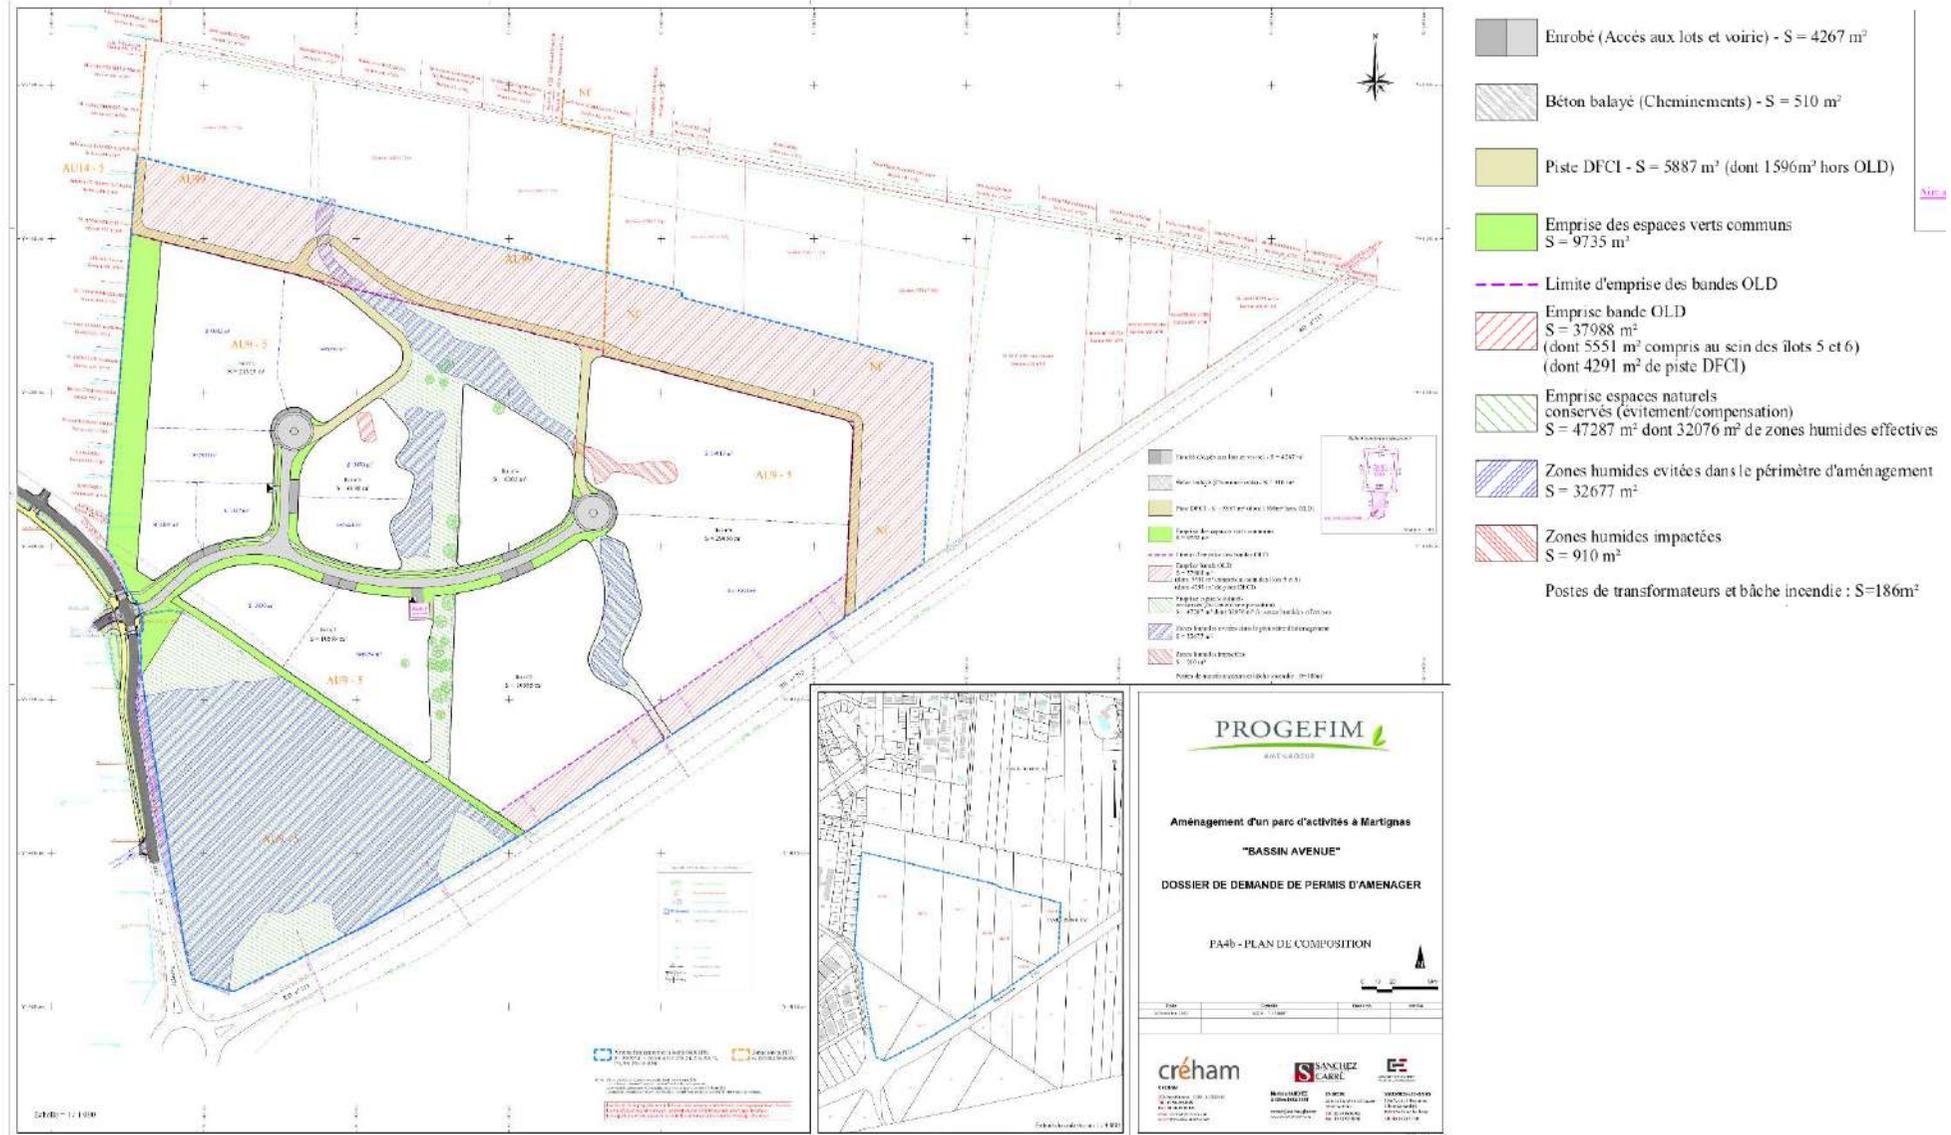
Plan de masse de projet (Créham, Janvier 2023)
